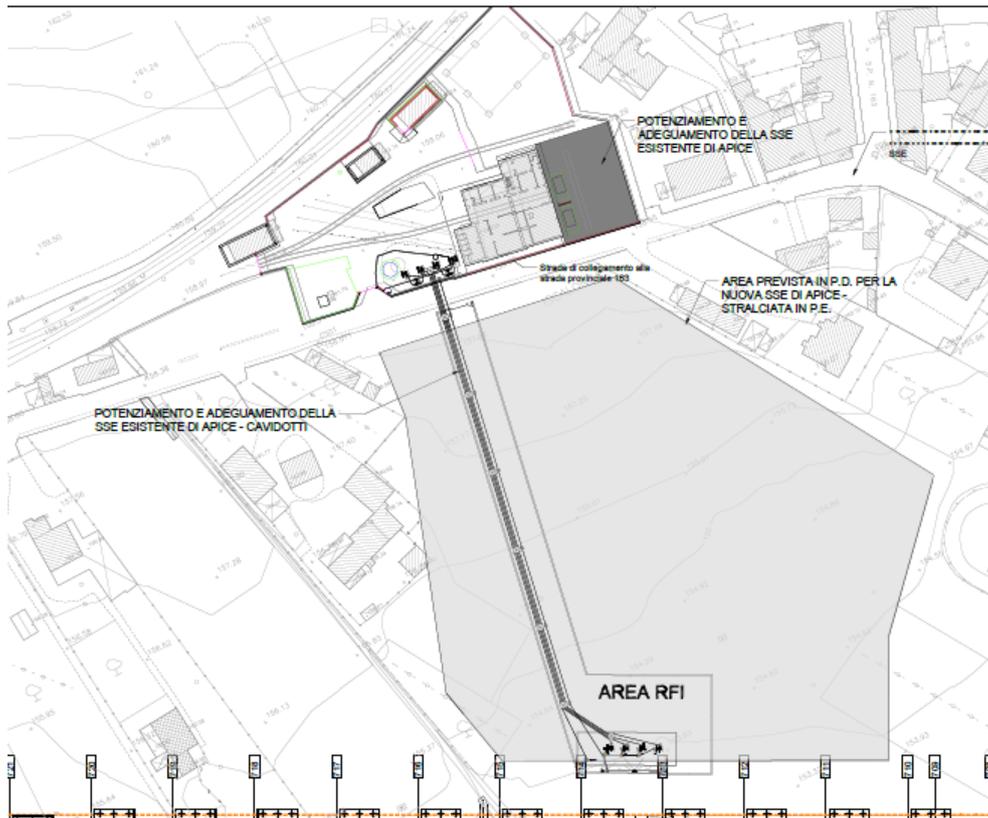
Planimetria della sistemazione del piazzale SSE Apice come da prescrizione in oggetto
